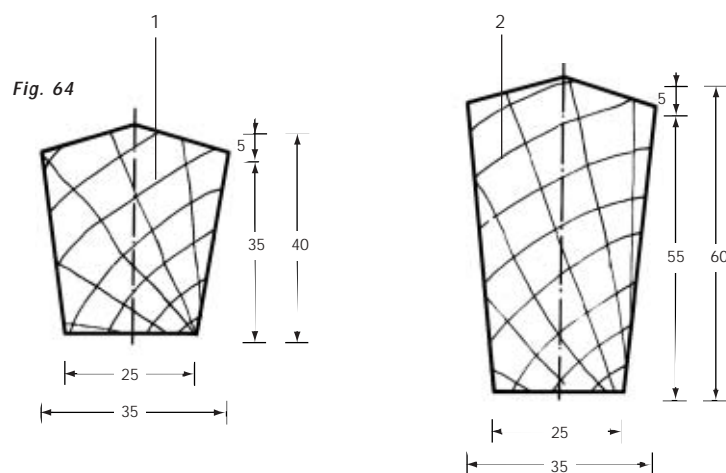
Caibros pentagonais de madeira para uso das juntas elevadas.
